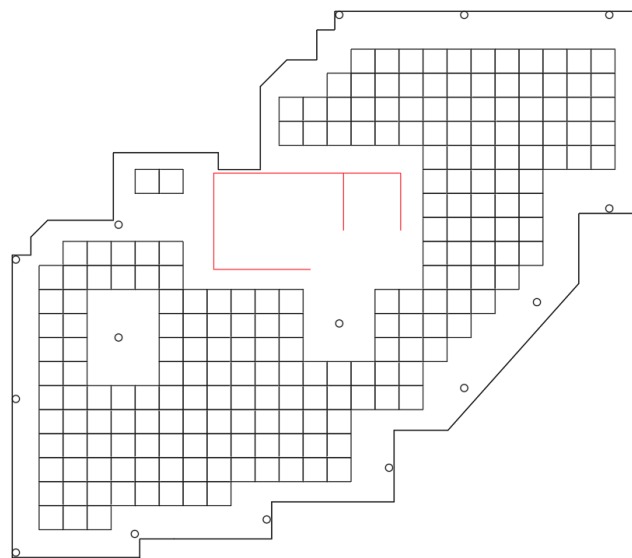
Vista em planta da laje fungiforme aligeirada com a distribuição dos blocos.
